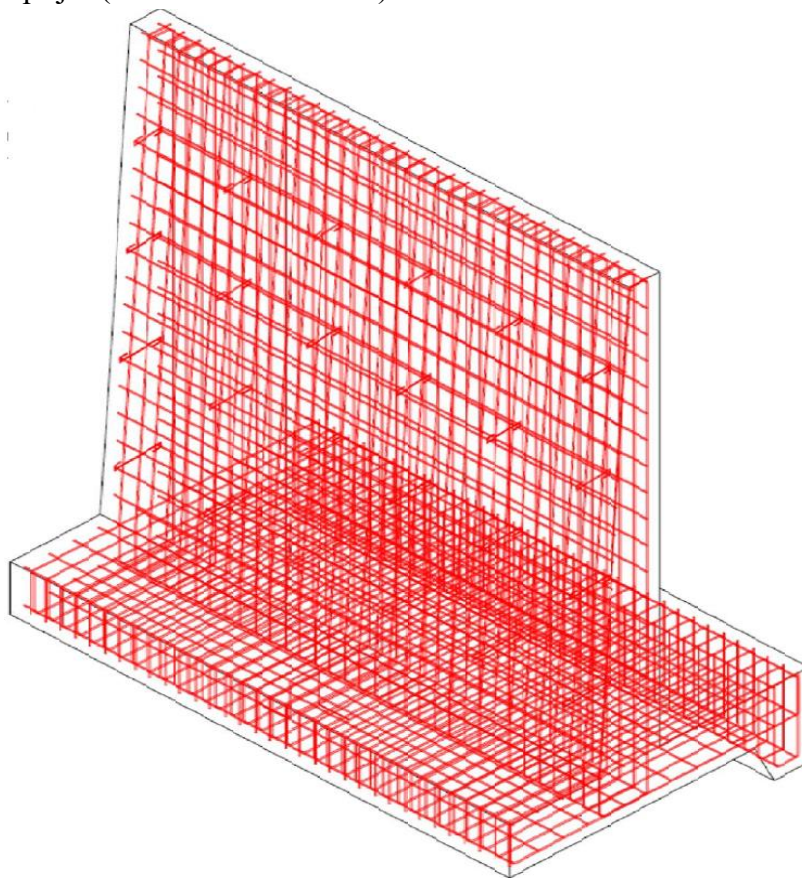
Exemplu orientativ armare tronson zid de sprijin de beton armat (vedere axonometrică)
